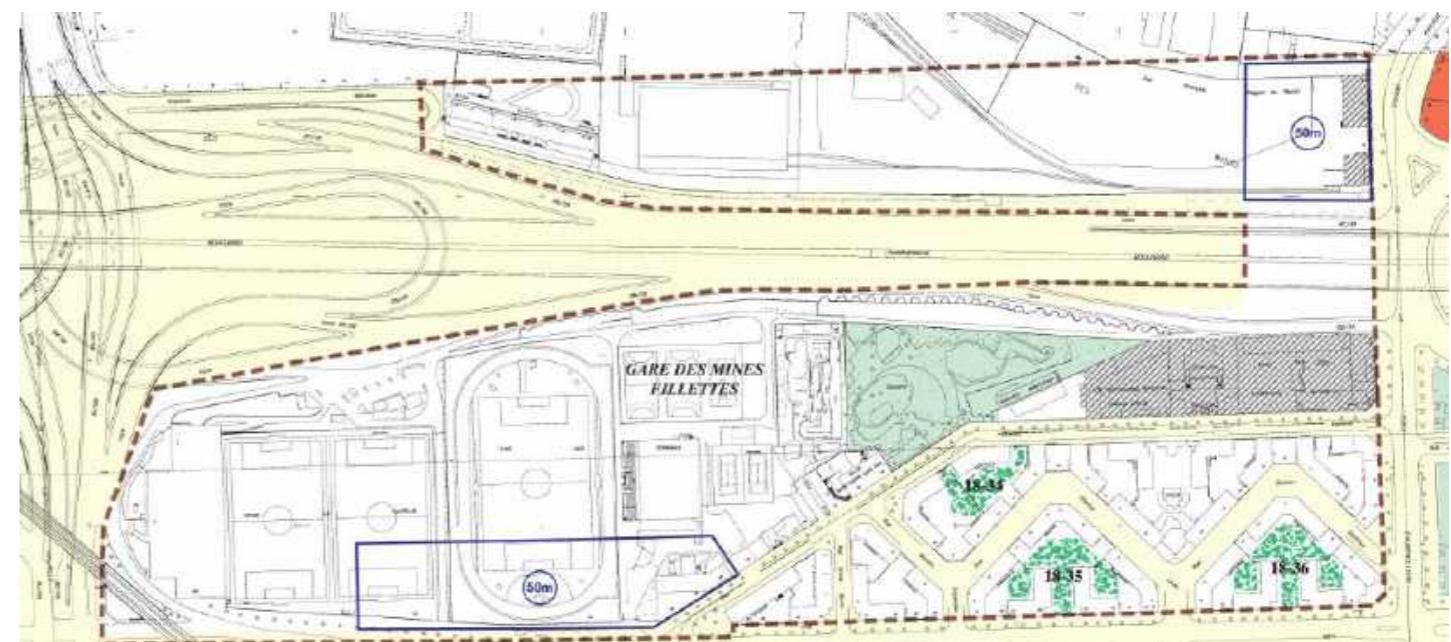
Plan des périmètres de Hauteur Maximale de Construction
